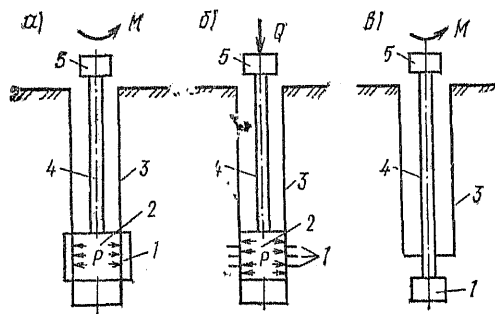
Схемы испытаний грунта в скважинах на срез
